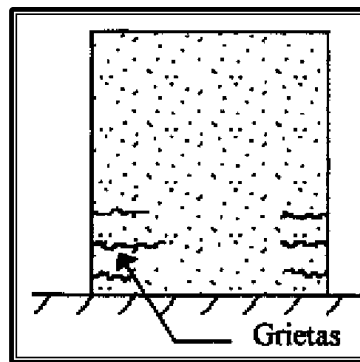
Grietas casi horizontales en los extremos de la base del muro (Fallas por flexión)
